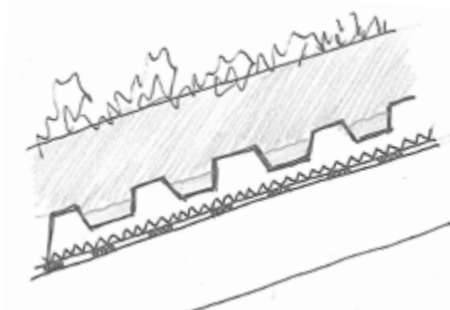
Cubierta inclinada 10-25° con capa drenante.
